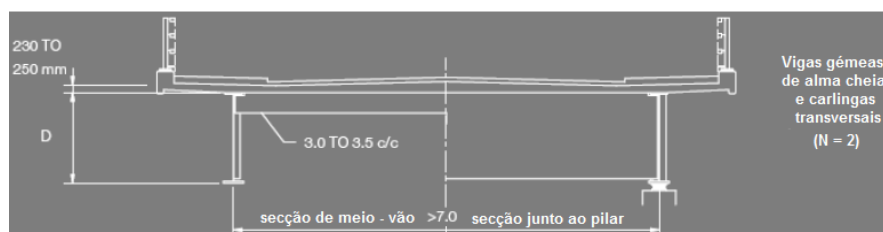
Esquema tipo de uma secção transversal constituída por duas vigas gêmeas de alma cheia e uma *haunched slab* (Hayward, A. 2005).
